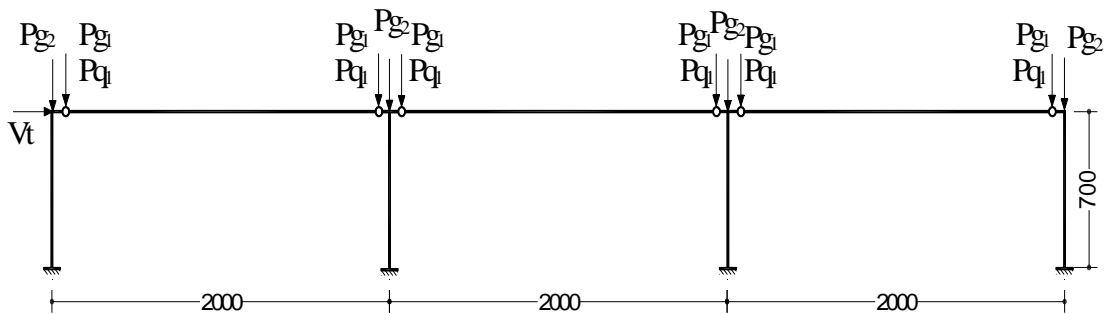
Seçilen betonarme prefabrike endüstri yapısı
